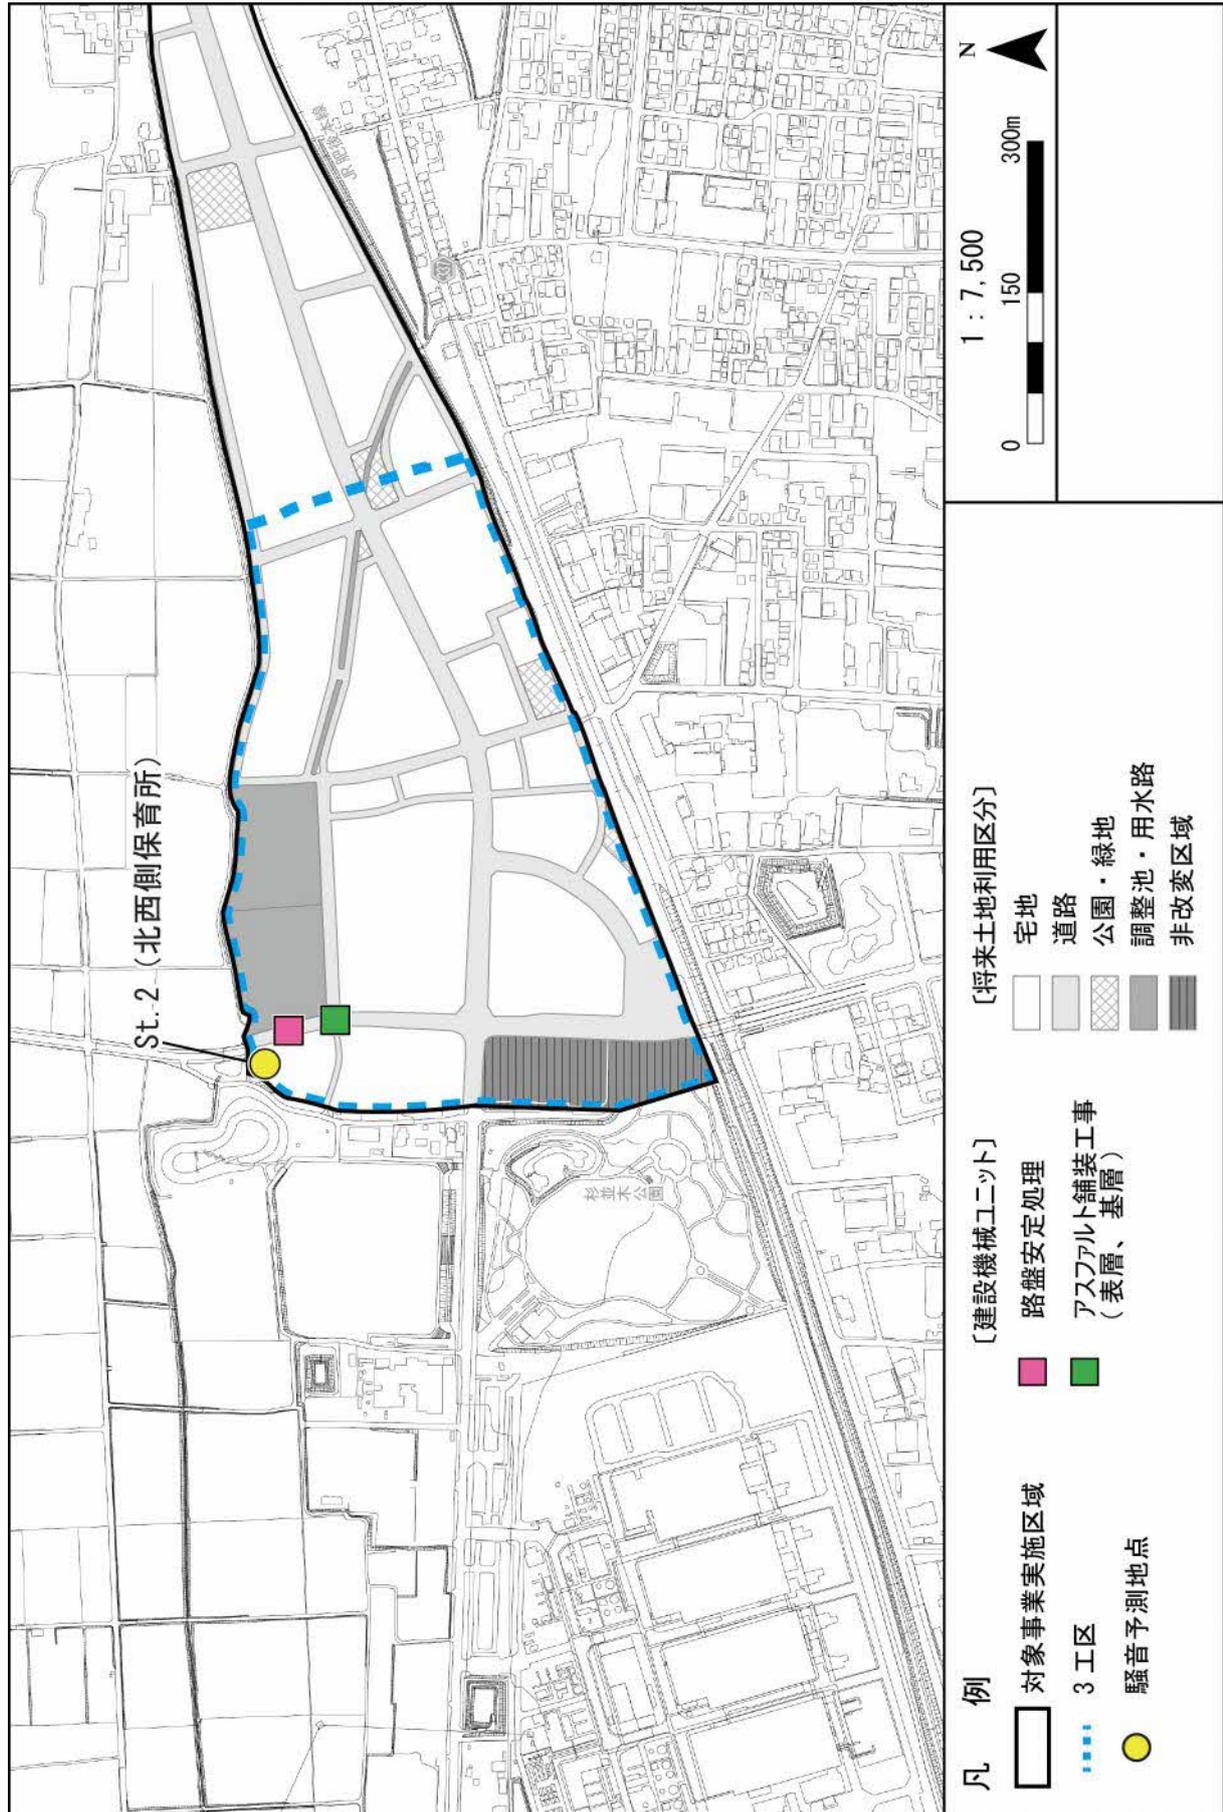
(4) 3 工区における建設機械ユニット配置図 (パターン④)
